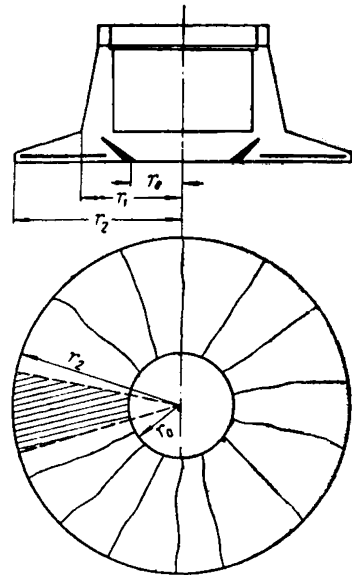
Схема разрушения нижней плиты фундамента с образованием конической трещины
